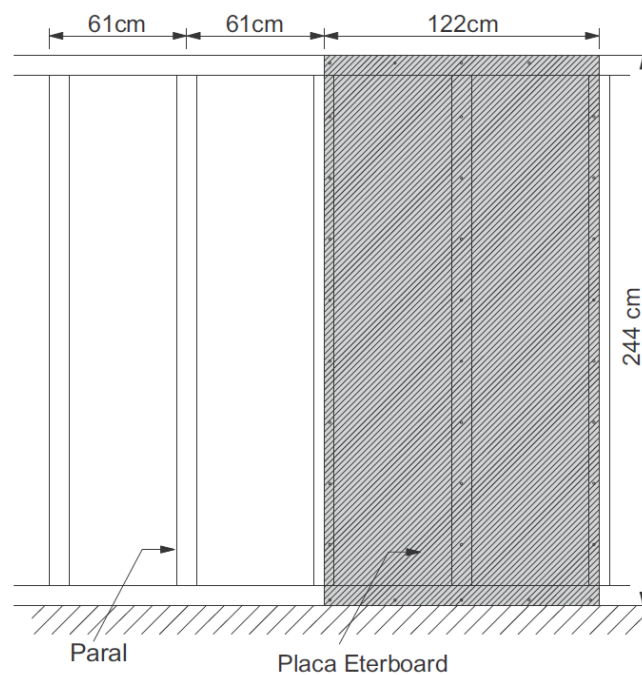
Separación para la subdivisión horizontal de la estructura
